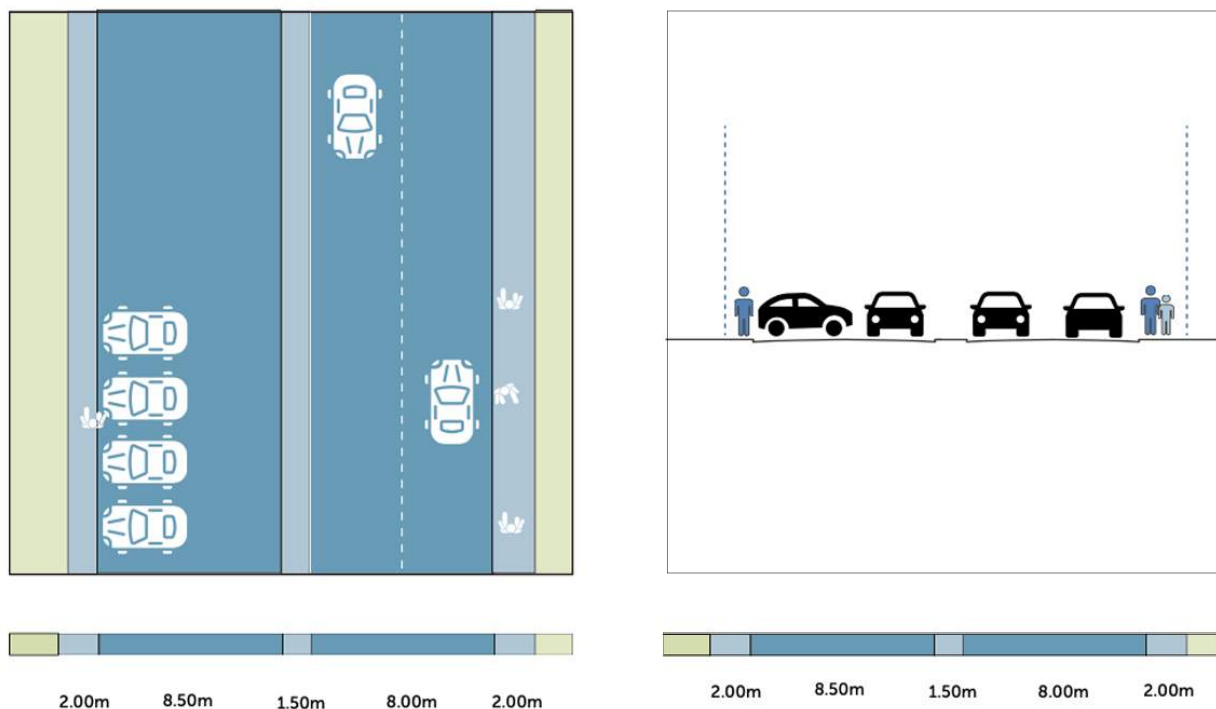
Str. Baba Novac: reprezentare în plan și secțiune transversală. sursă: autor
